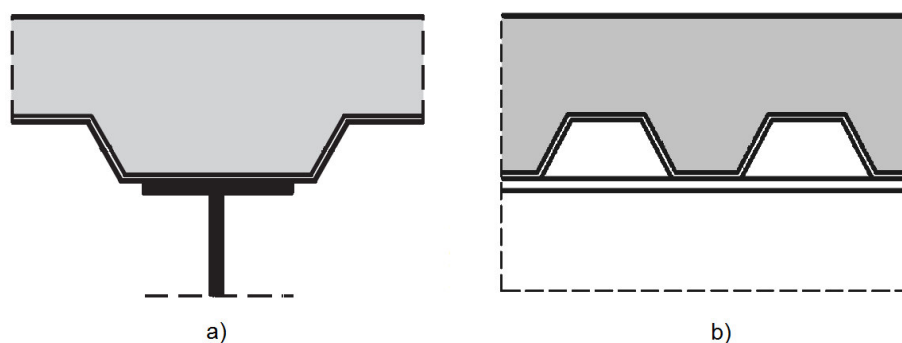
Chapa perfilada. a) Chapa paralela a viga; b) Chapa transversal à viga. (adaptado de NP EN 1994-1-1, 2011)
